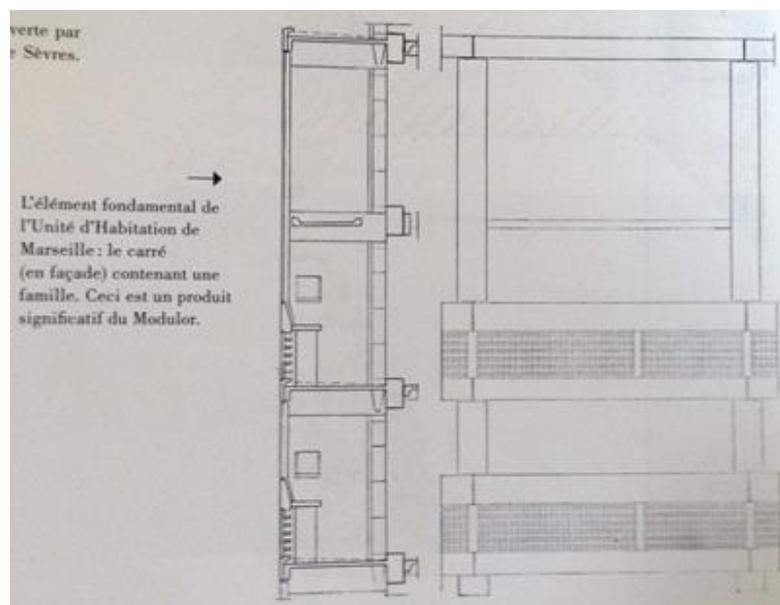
Pormenores da fachada e corte do elemento de *brise-soleil* nos alojamentos
